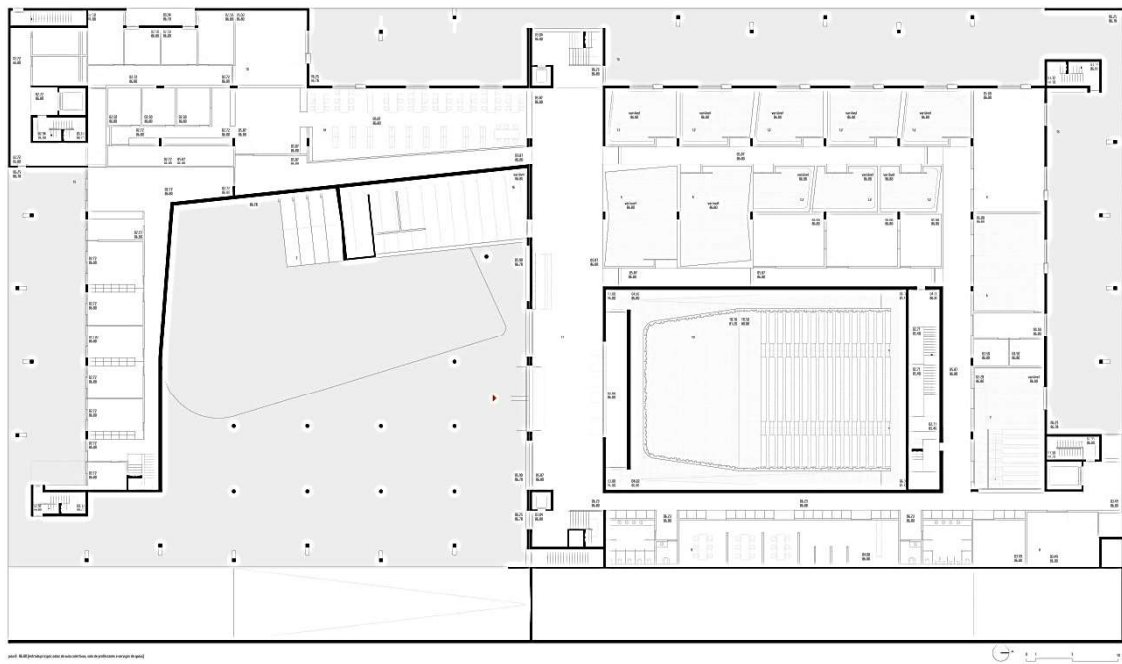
Planta do pavimento térreo. (Fonte: Open Buildings, 2013)
